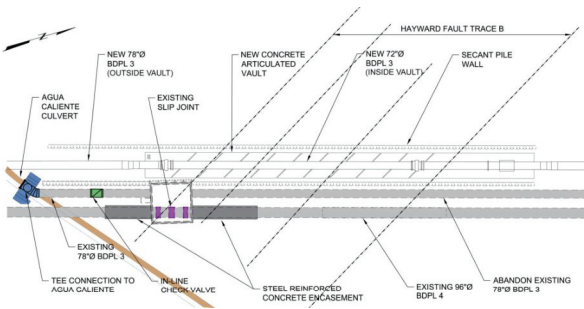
BDPL3 號管線於 Trace B 處的設計平面圖
